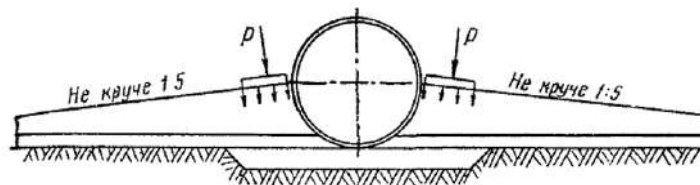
Схема засыпки и уплотнения грунта наклонными слоями
